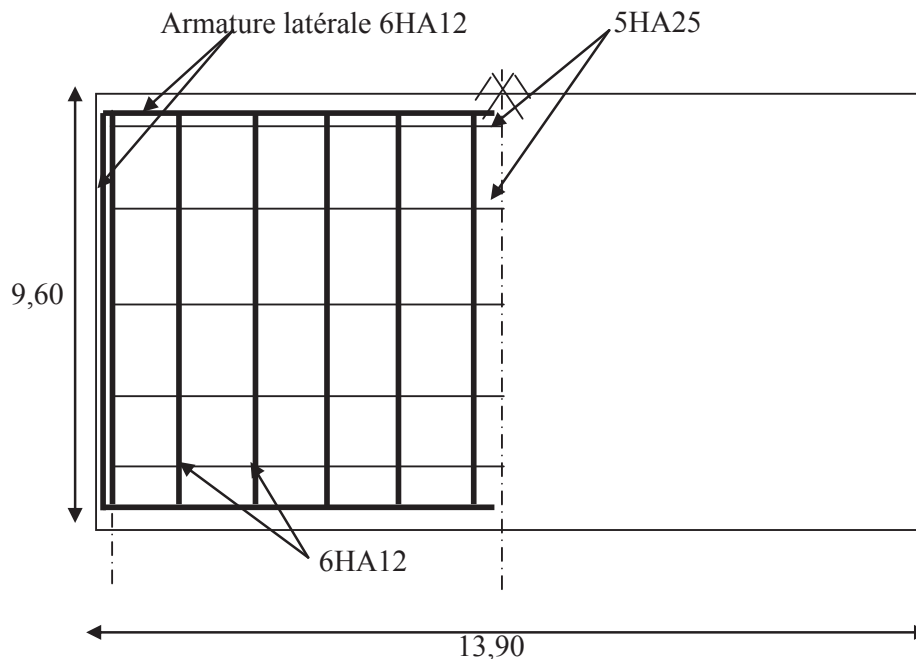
Ferrailage de la semelle (nappe supérieure)
